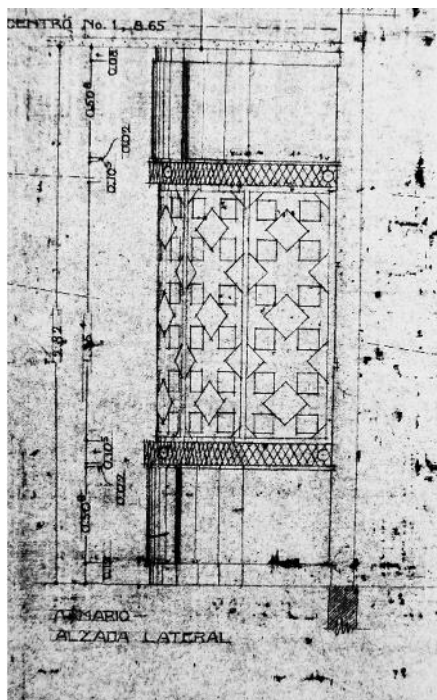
Corte y alzado del mueble que continuaría el muro.
